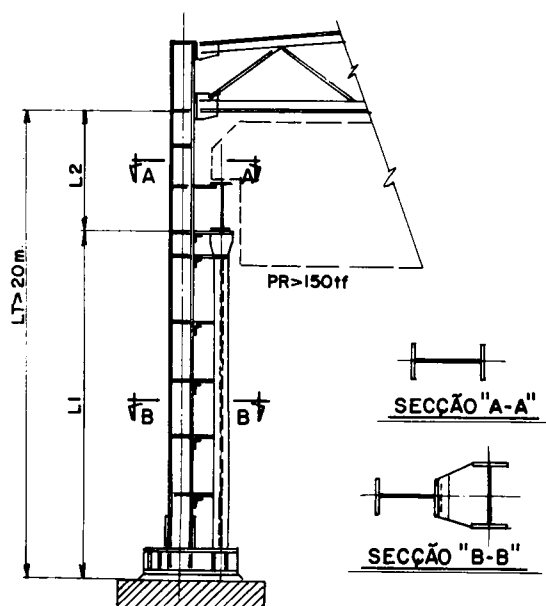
Coluna com um suporte para a viga de rolamento
